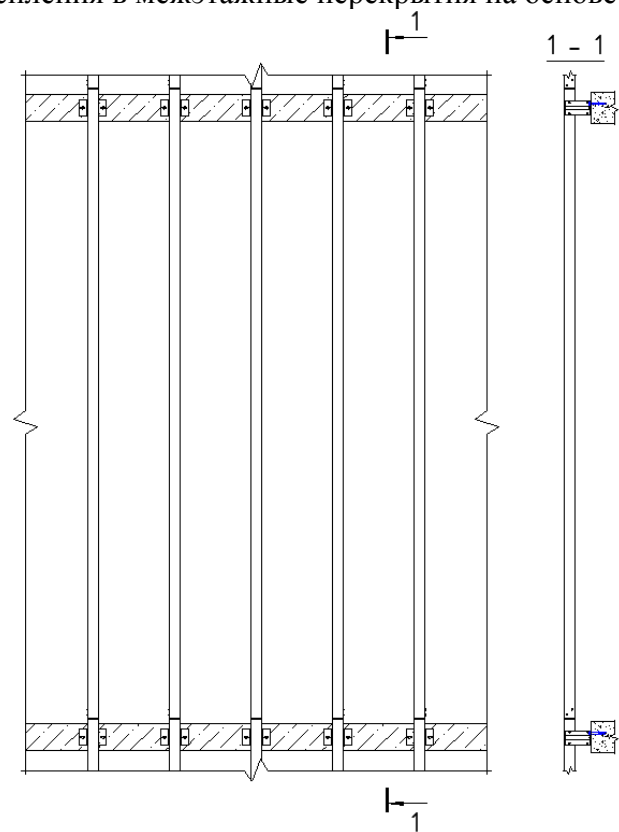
Система крепления в межэтажные перекрытия на основе кронштейна КНс-28/1 и профиля ПК/1
